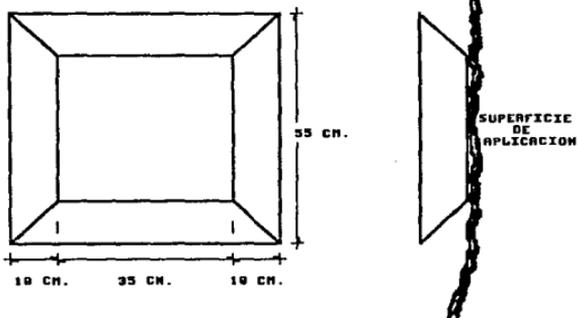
TABLERO DE PRUEBA ( artesa de madera ).
